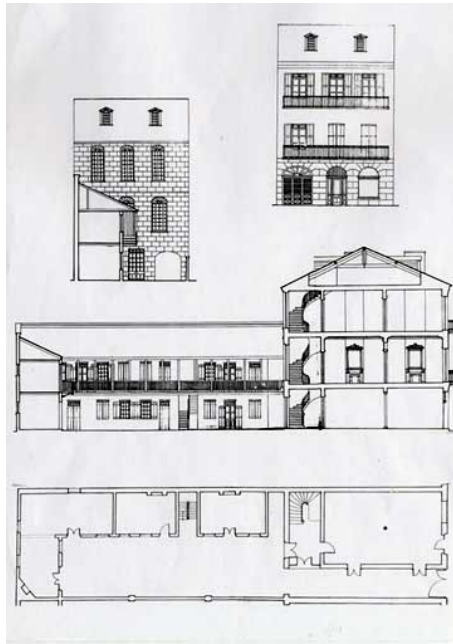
Plan du rez-de-chaussée, élévations et coupes d'un immeuble créole construit vers 1830 pour Nanette Prud'Homme, épouse de Guillaume Duparc, sur Royal Street, dans l'ancien quartier français. Comme de nombreux colons à cette époque, cet immeuble était un " hôtel particulier " qui permettait de loger la famille durant l'hiver, pendant la saison d'opéra. Cette saison était d'une grande importance sur le plan social. Le reste du temps, la famille Duparc vivait dans son habitation sur les rives du Mississippi, à La Vacherie. Relevés C. Charlery © C. Charlery
